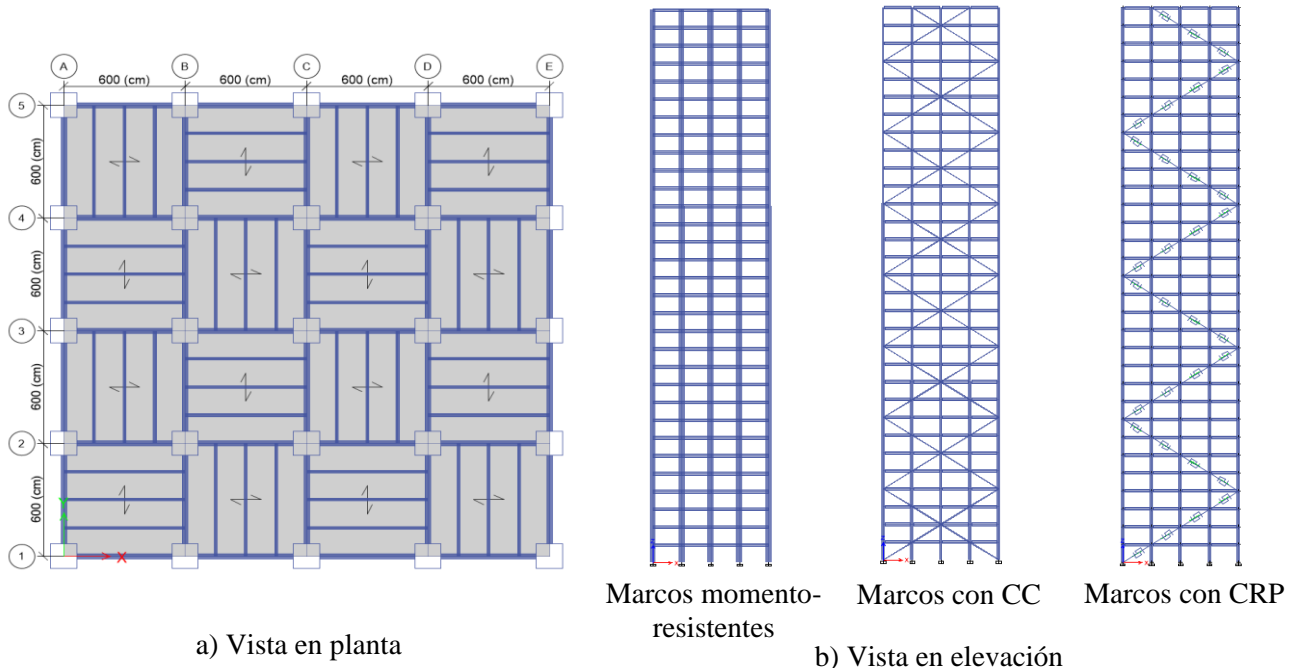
Vista en planta y elevación de edificio en estudio de 31 niveles
